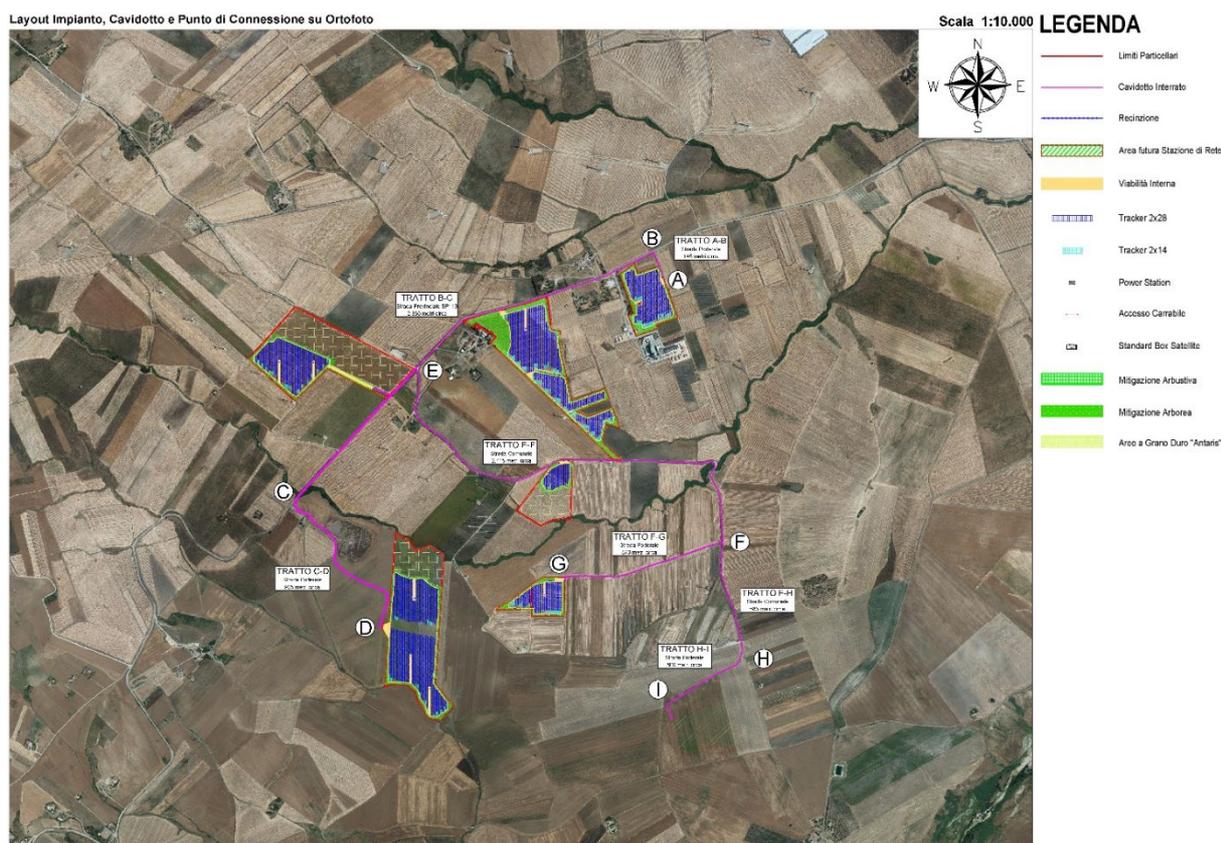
Layout del futuro impianto FV_ CIOMMARINO su Ortofoto
